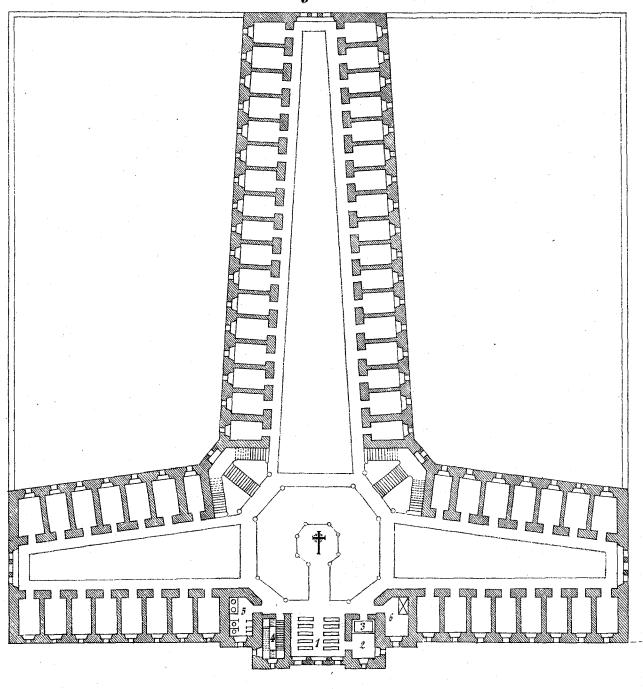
ª.	Edificie	o del primer p	verioa	loPlanta baja	Escala	1: 400
